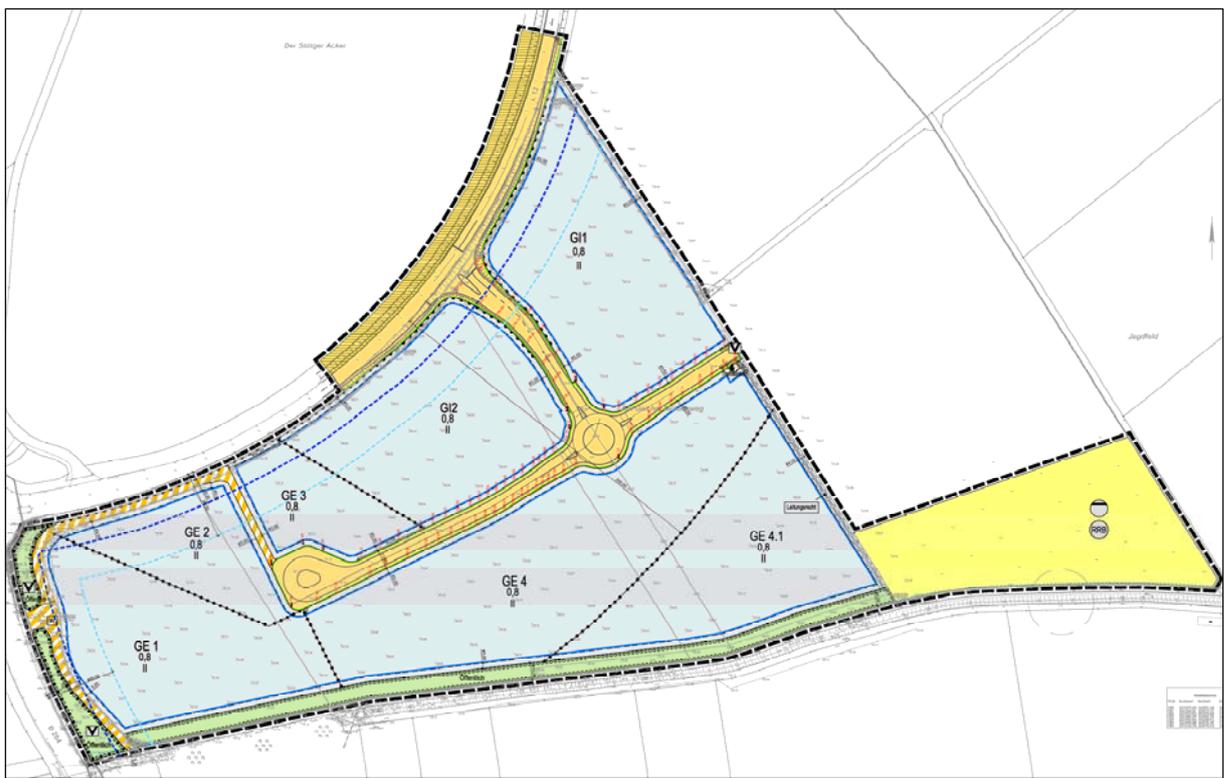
Planzeichnung des Bebauungsplans (Auszug)
